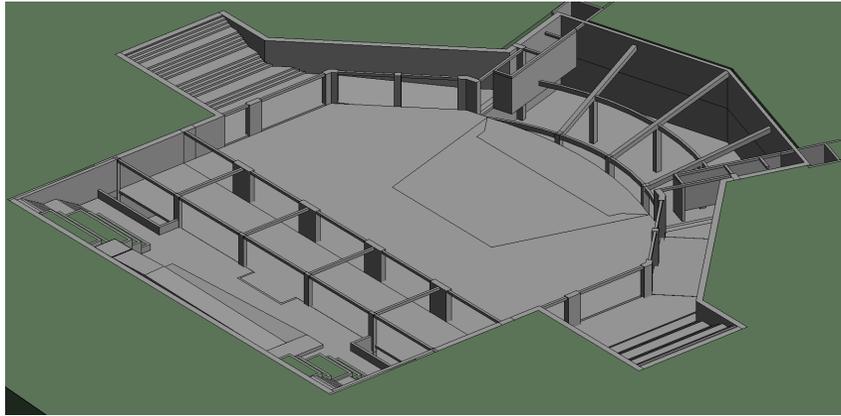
Propuesta estructural nivel de escenario NPT -3.40 m
